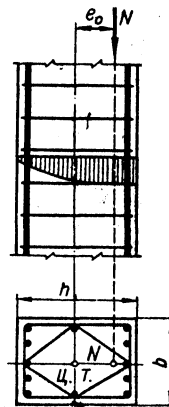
Расчетная схема внецентренно сжатого элемента.
